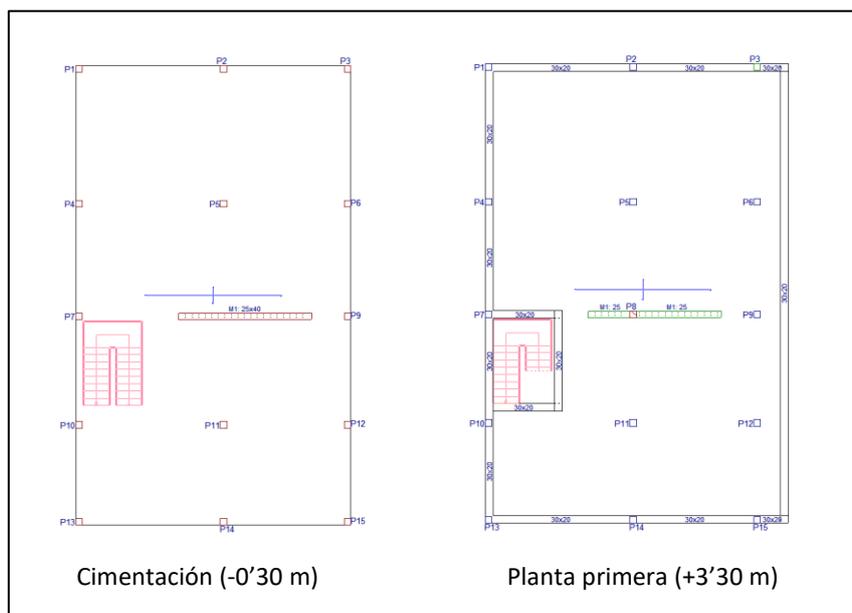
27. Recorte de pantalla, Vistas plantas con núcleo de escaleras en Cypecad
